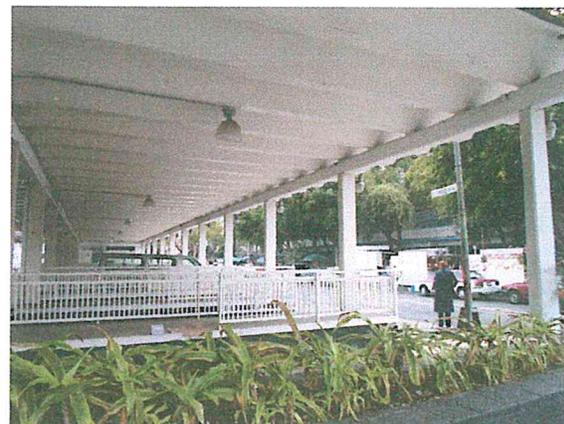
y 26. Trabes, columnas y techumbre en "W" de concreto armado prefabricado de la zona de EMBARQUE.
